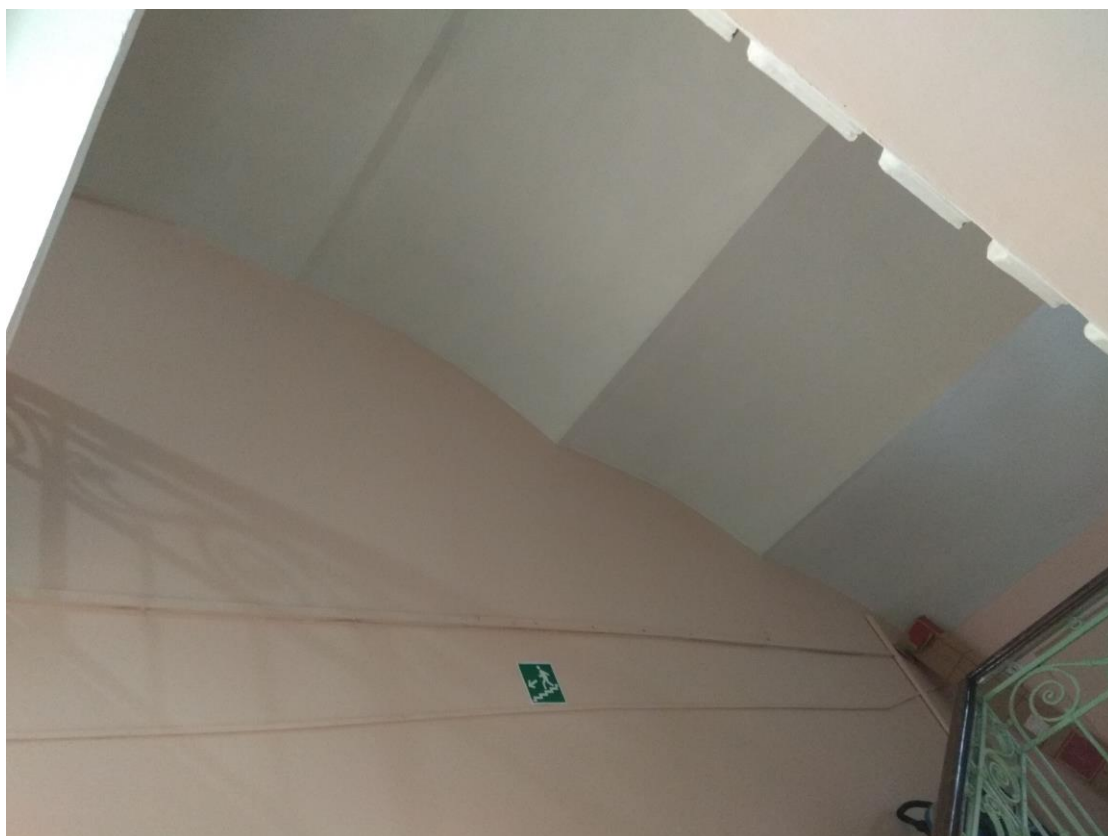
Перекрытие над лестничной клеткой в осях 8-9/Д-И #2
